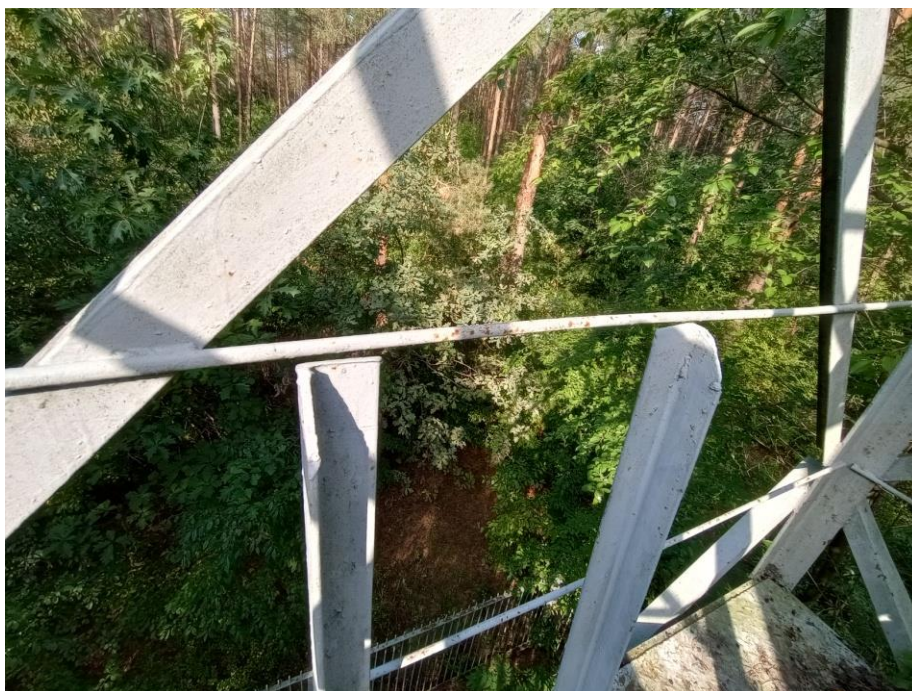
Wieża przeciwpożarowa – konstrukcja
